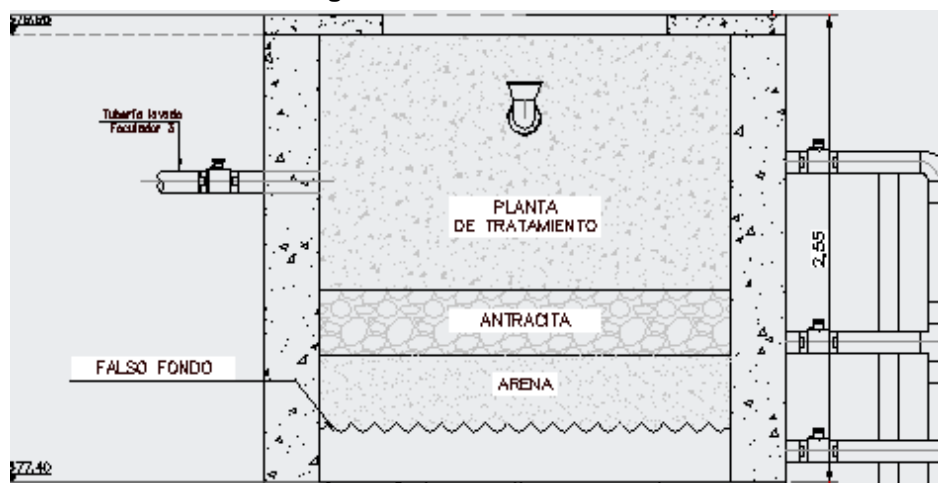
Detalle De Tuberías De Lavado Del Sedimentador
